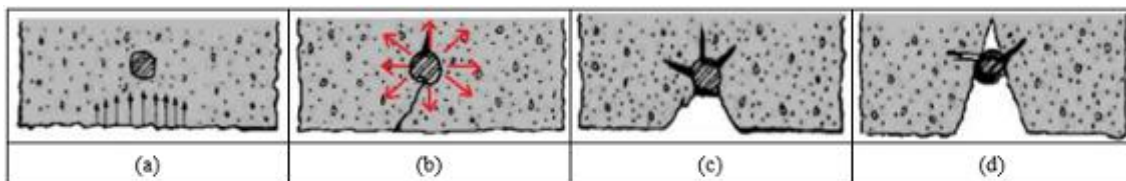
Instalação da corrosão na armadura: (a) Penetração de agentes agressivos; (b) Fissuração em virtude de forças de expansão dos produtos da corrosão; (c) Lascamento do concreto e corrosão acentuada; (d) Lascamento acentuado e redução da seção da armadura. Fonte: adaptado de Helene (1986).
